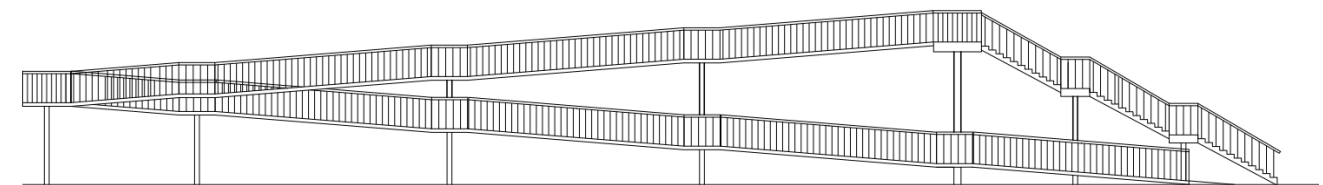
Alzado y rampa escaleras; Fuente: Elaboración propia
